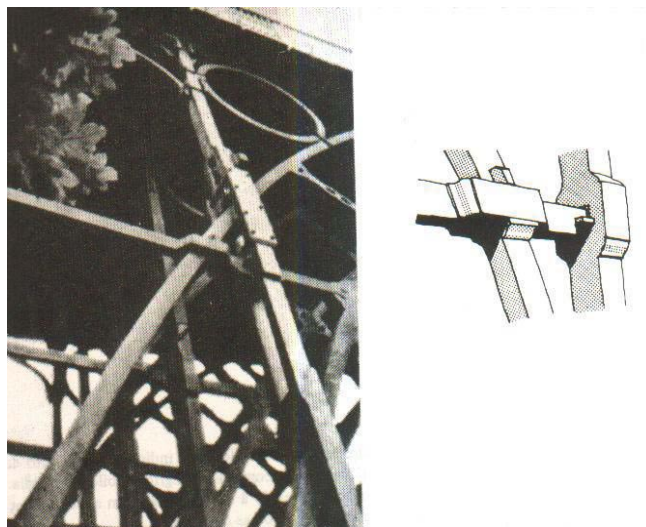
Iron Bridge: detalhe do encaixe semelhante aos que eram feitos em madeira
